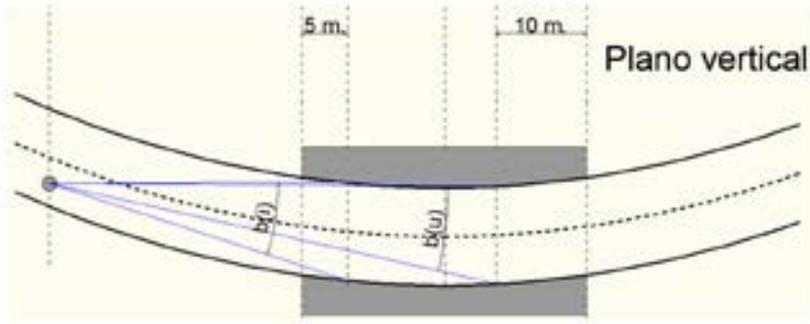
Plano longitudinal y plano vertical. (Continuación).
